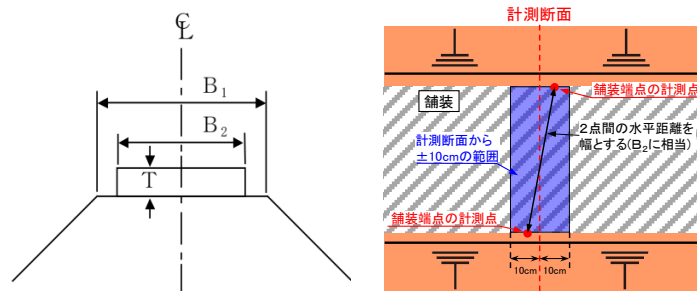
出来形測定箇所標準図（左：横断面、右：平面図）
